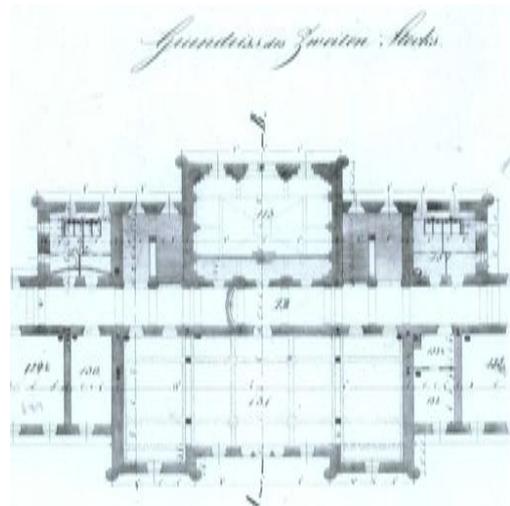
k. k. Kadetteninstitut, Mitteltrakt, Grundriss 2. Stock, Ausschnitt, 1859
